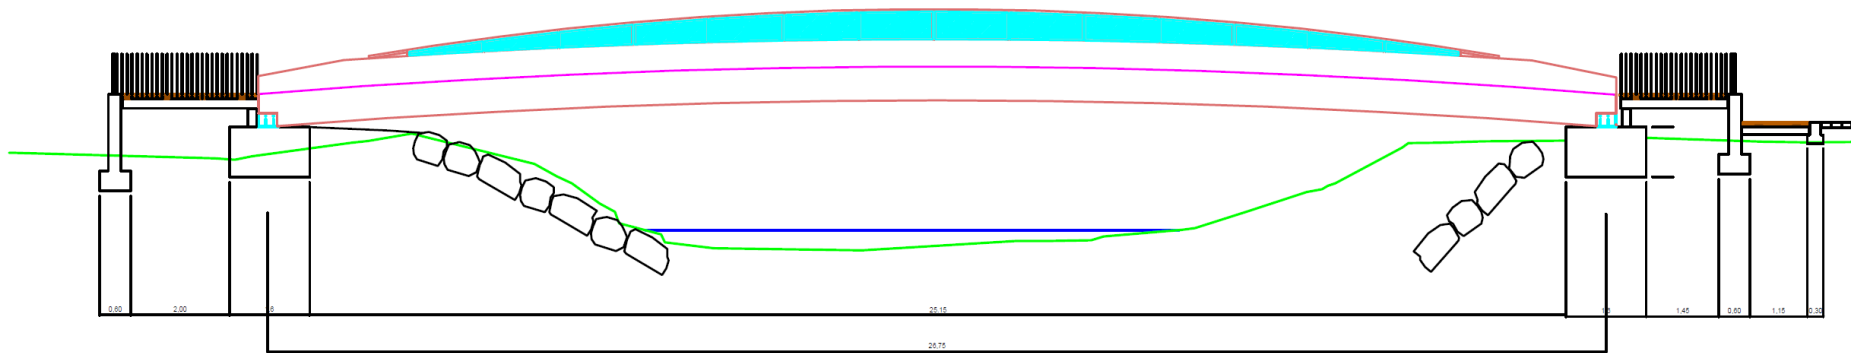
Detalle constructivo en alzado de pasarela ubicada en Villasuso de Cieza. Fuente: Yofra.
